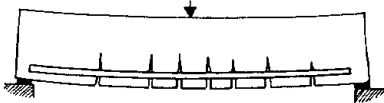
I jernbeton optager armeringen træk og betonen tryk. Derfor fokuseres indsats for at lave stærkere beton på materialets trykstyrke.
